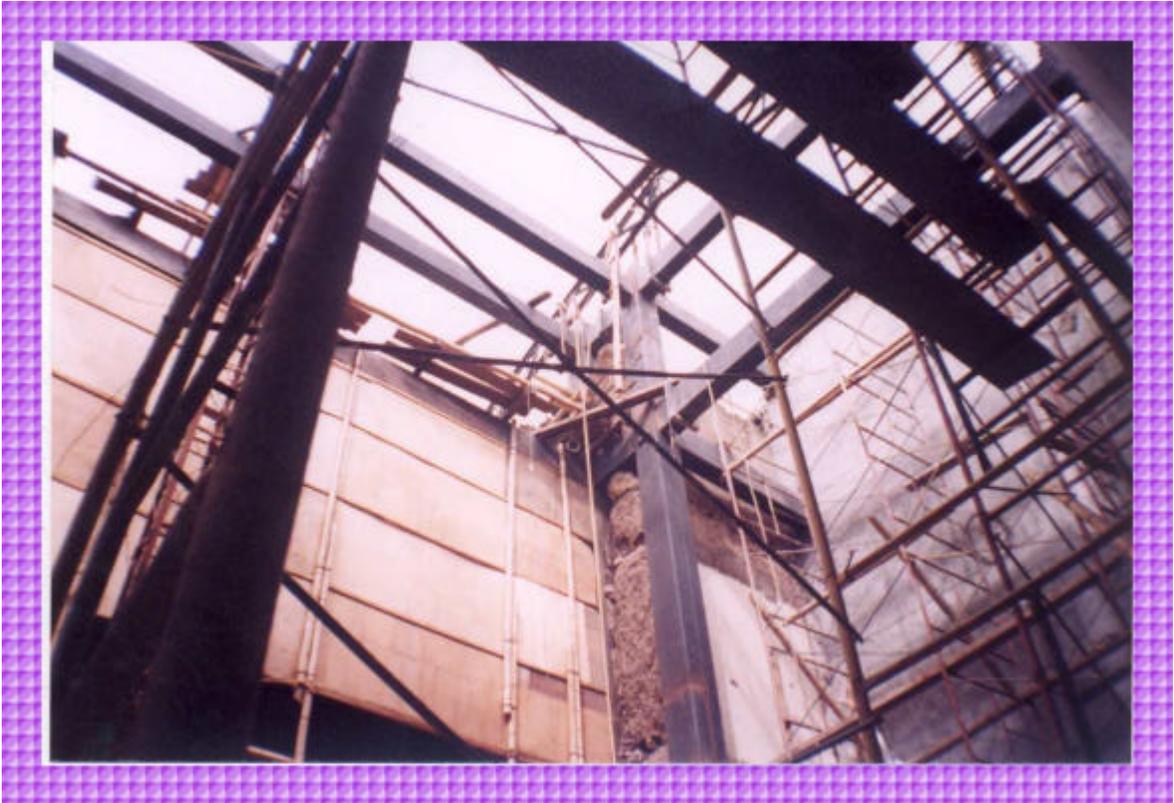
El sistema de trabajo empalme de elementos metálicos en la obra ha sido mediante pernos y soldaduras
